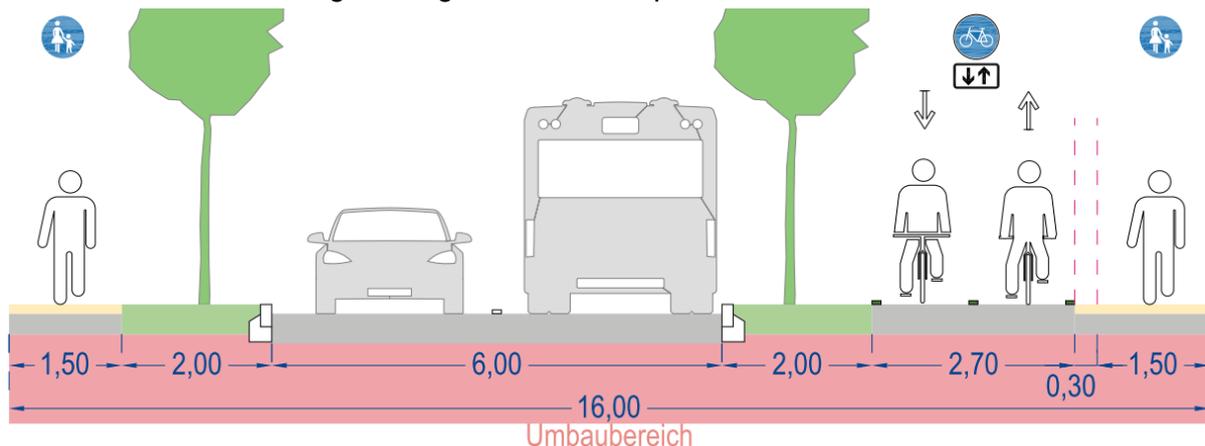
Straßenquerschnitt Planstraße B mit Zweirichtungsradweg und zwei Baumreihen mit Versickerungsmulden (Maße im Meter)¹⁰
